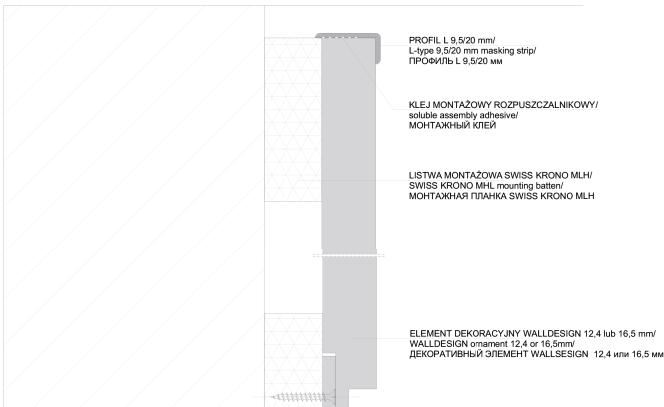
Uklad elementów dekoracyjnych WALLDESIGN
